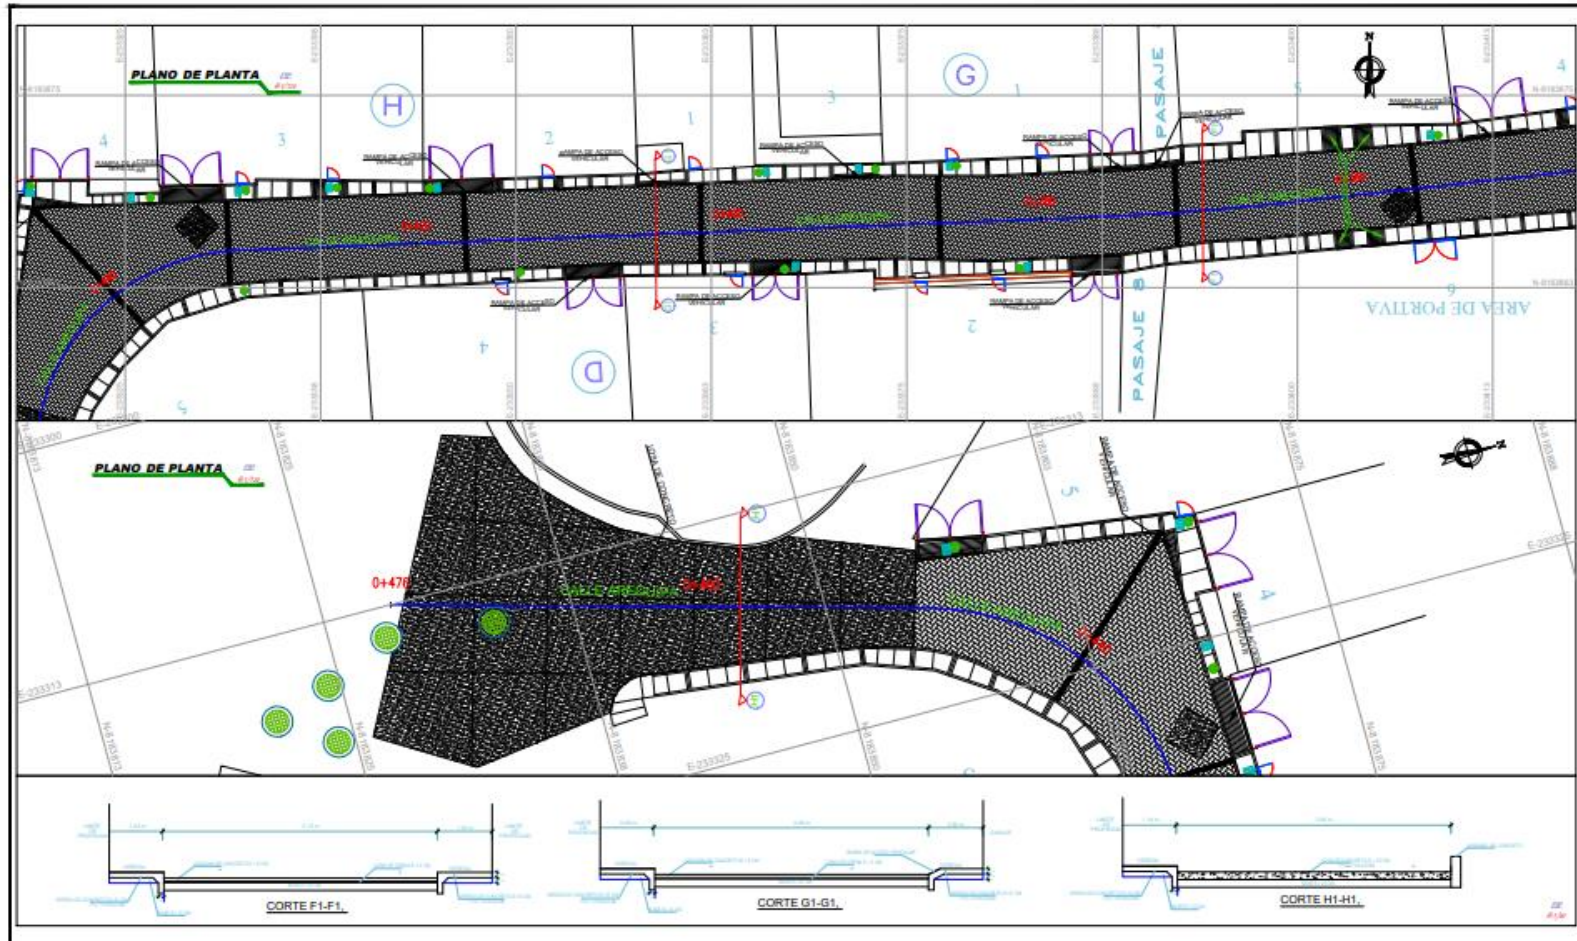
Planimetría de la construcción de muros de contención tramo 3.A1.
